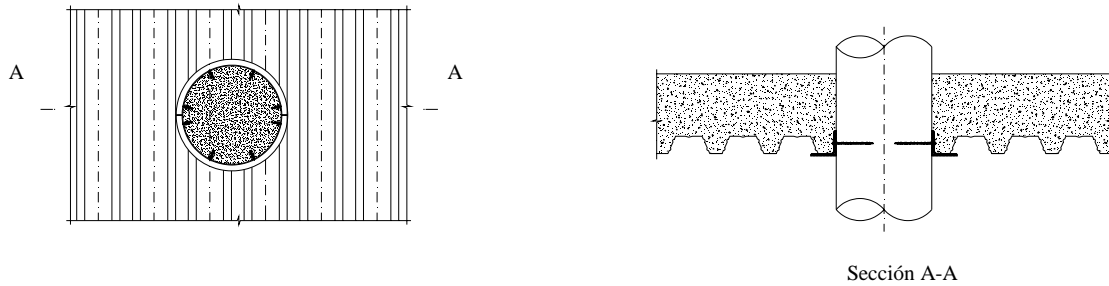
Encuentro de pilar circular de hormigón y forjado mixto
